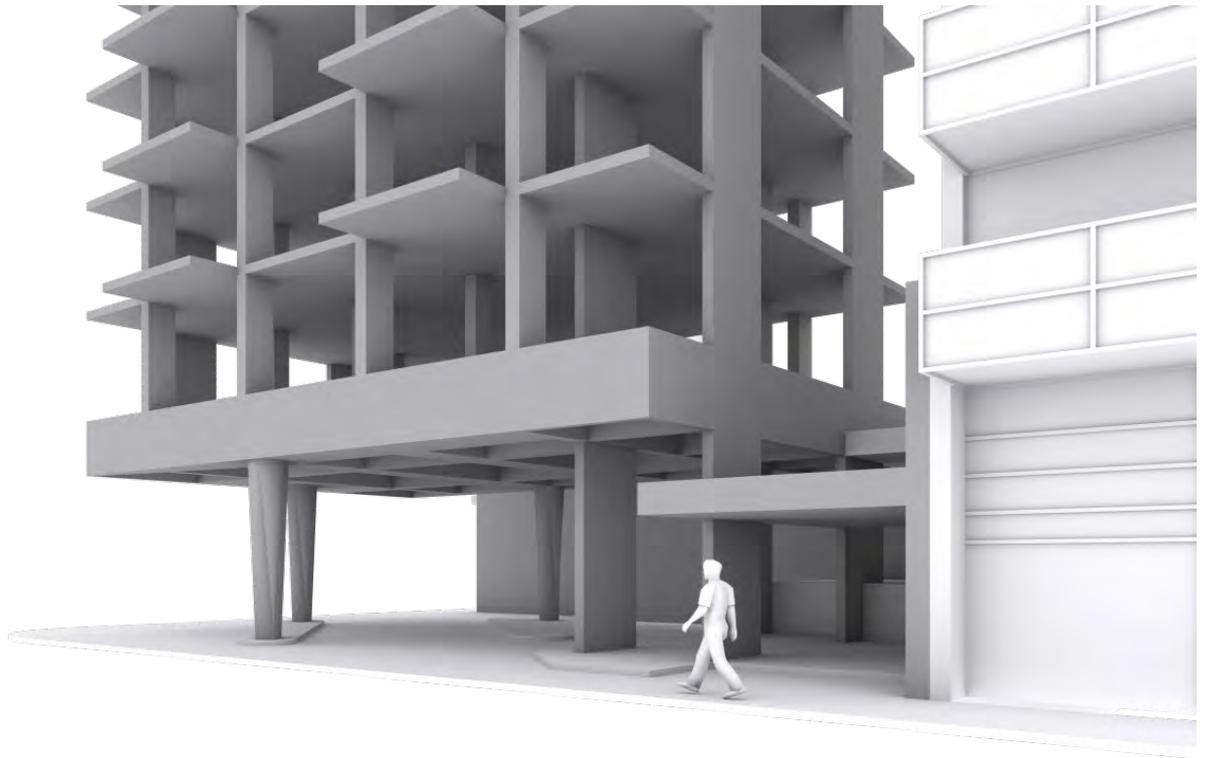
Detalhe da solução formal da estrutura de suporte no pavimento térreo desde a Rua Paraguay.
